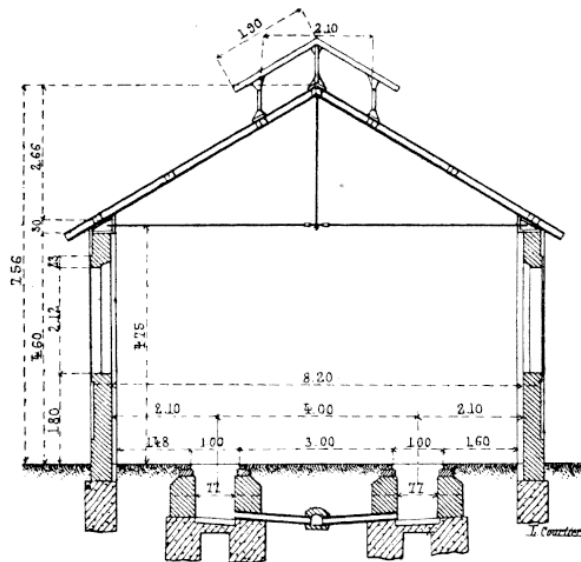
TYPE DE REMISE POUR 4 MACHINES.
